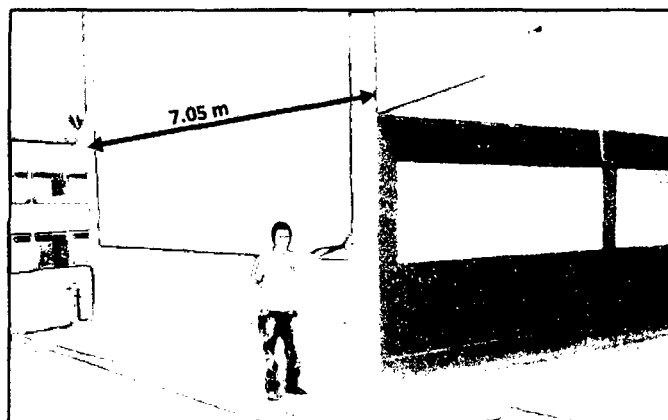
Pabellón 2. Separación máxima entre los apoyos laterales de la viga.
